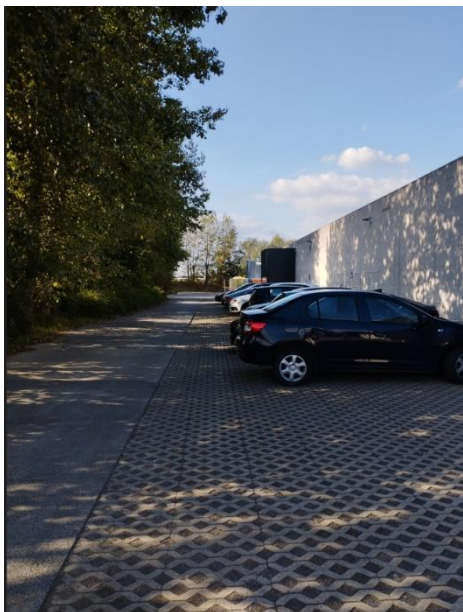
Eigen beeld, Ontharde parking site Empire Carpets
